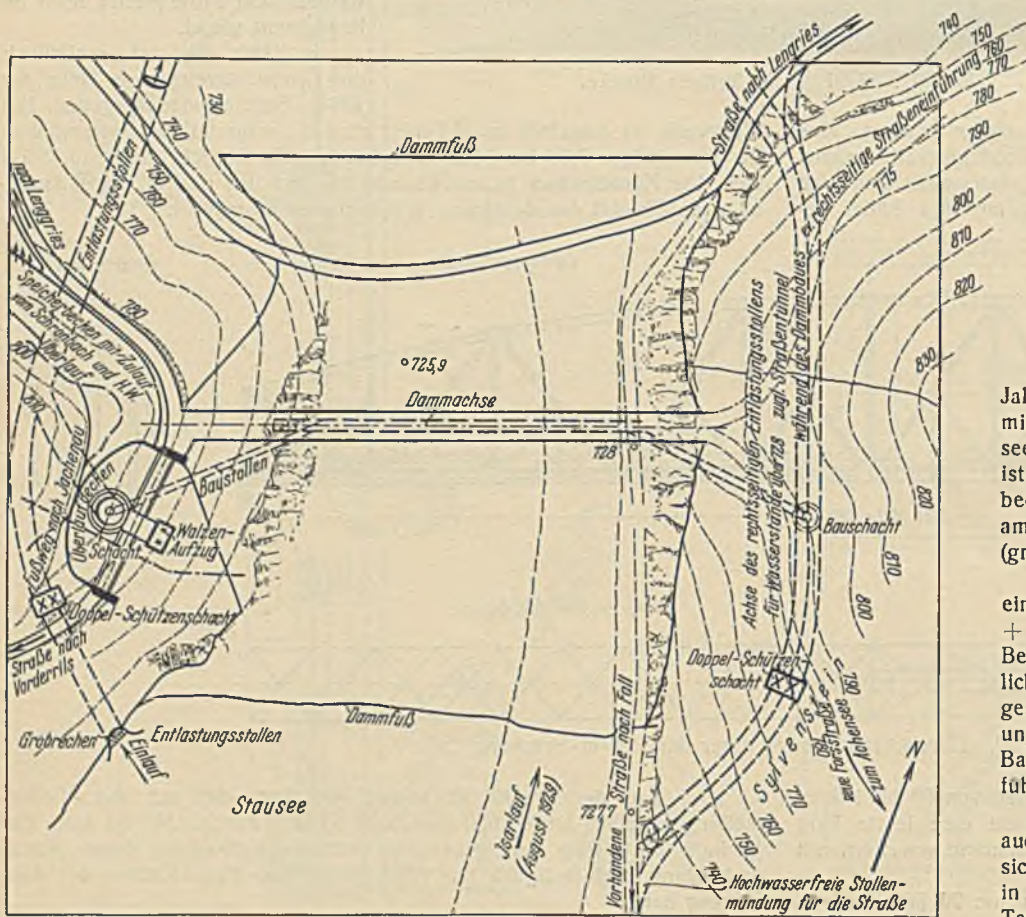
Grundriß der Isarklamm bei Sylvenstein mit Damm, Wegeverlegungen, Bau-Entlastungs- und Kraftstollen und Überlauf.
